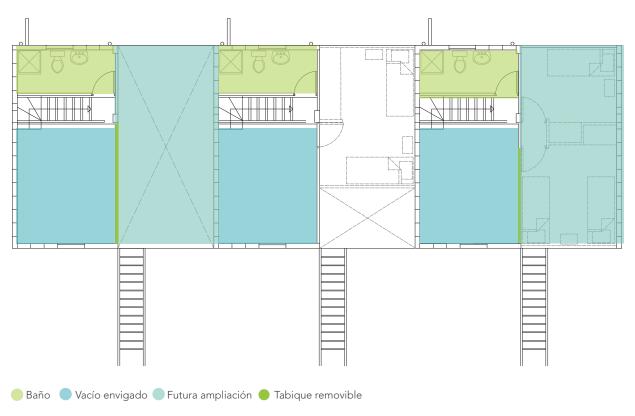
Planta Vivienda Piso 3 Nota: Elaborado por el autor
